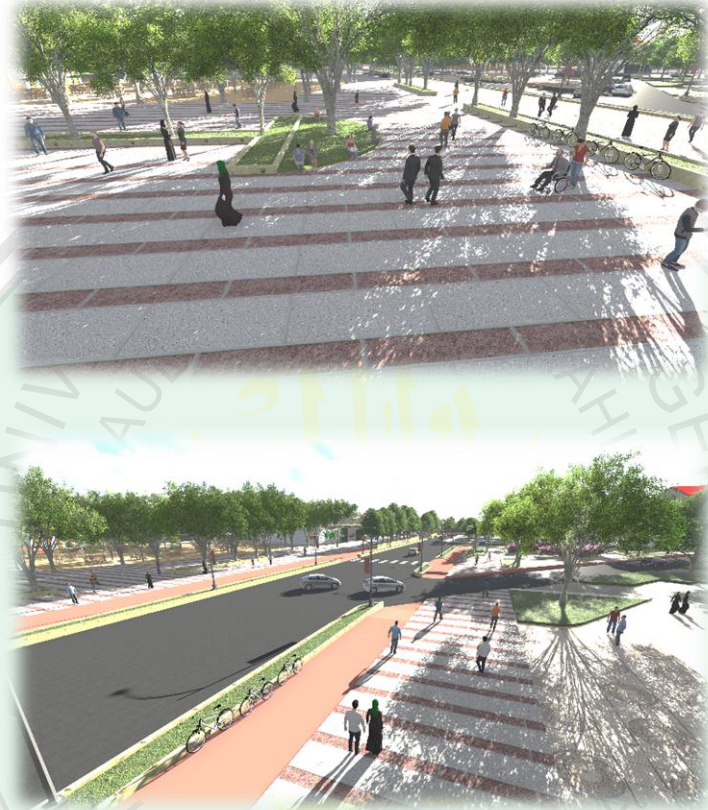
Detail Ukuran Jalur Sirkulasi
